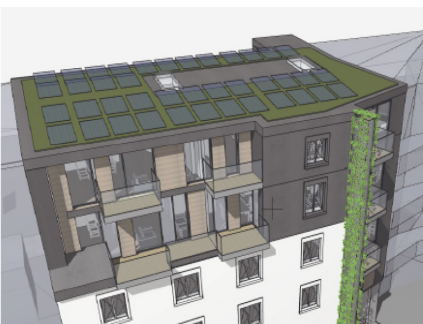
Hof- und Straßenansicht der Aufstockung und Erweiterung
